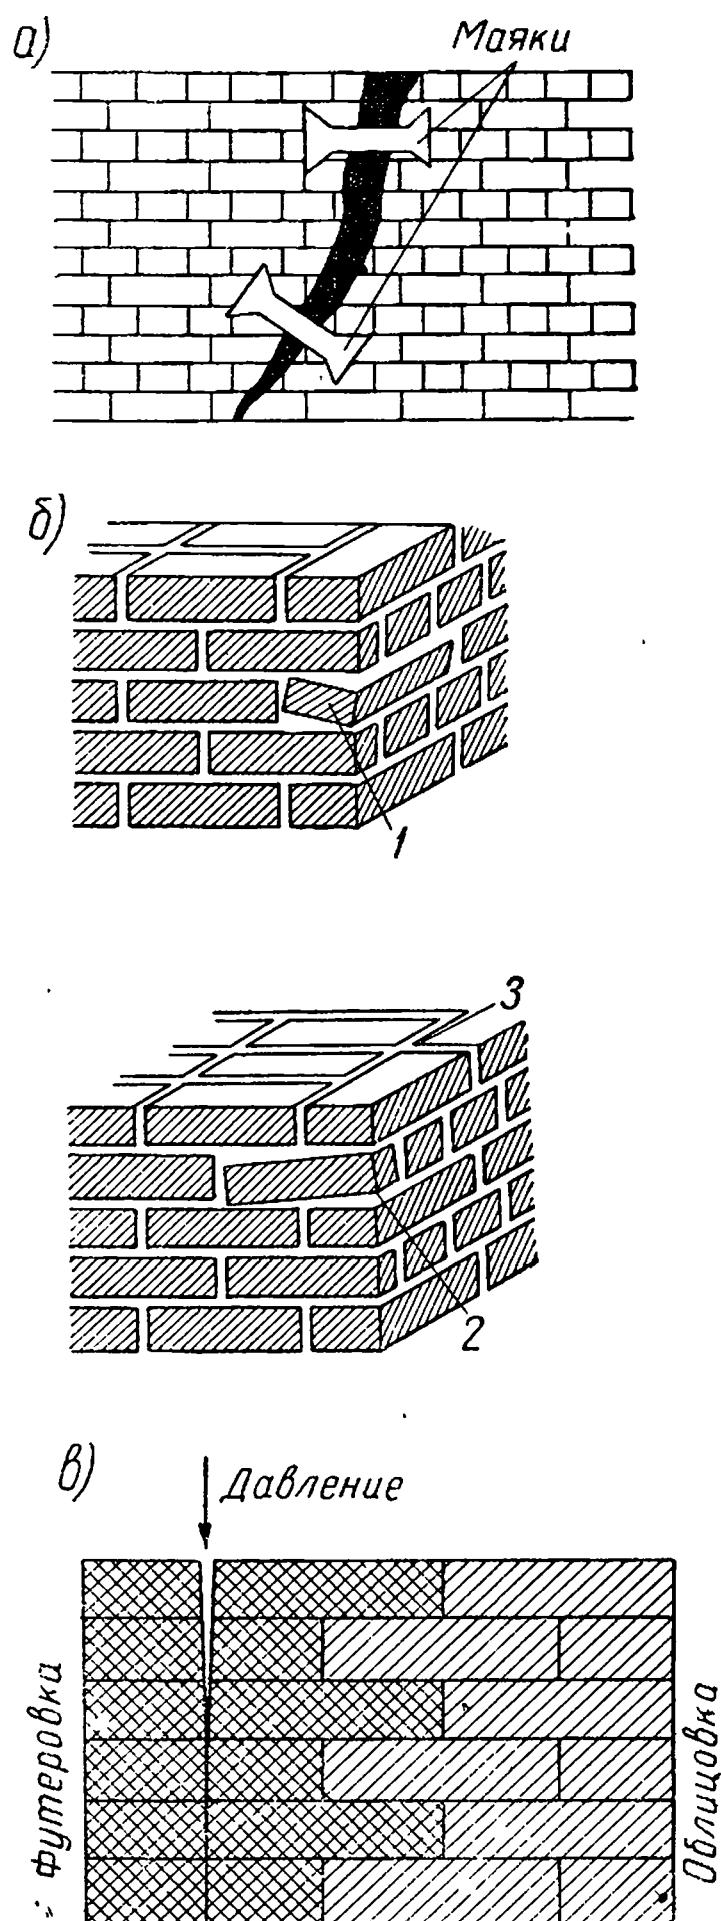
Дефекты обмуровки: а — трещина в обмуровке от осадки фундамента котла; б — брак в кладке угла облицовки; в — брак в кладке футеровки — расслаивание кладки из-за отсутствия перевязки.
